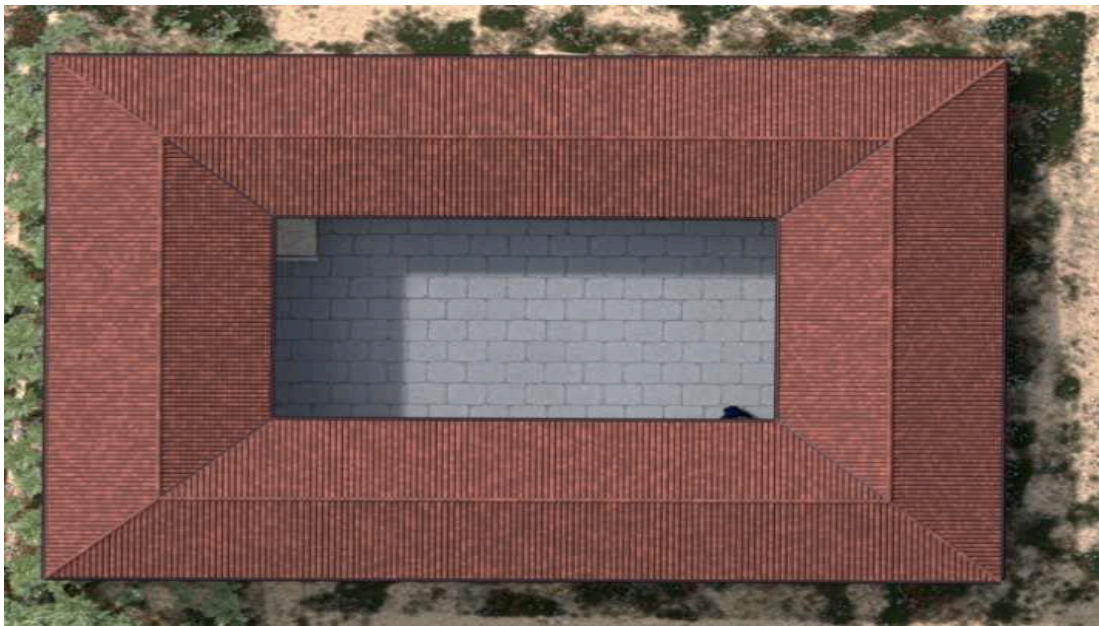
Imagen de la salazón Punta Moreiras. O Grove. Planta con cubierta dos aguas. Nota. Cubierta de la salazón de Punta Moreiras reconstruida en 3D. Elaboración propia
